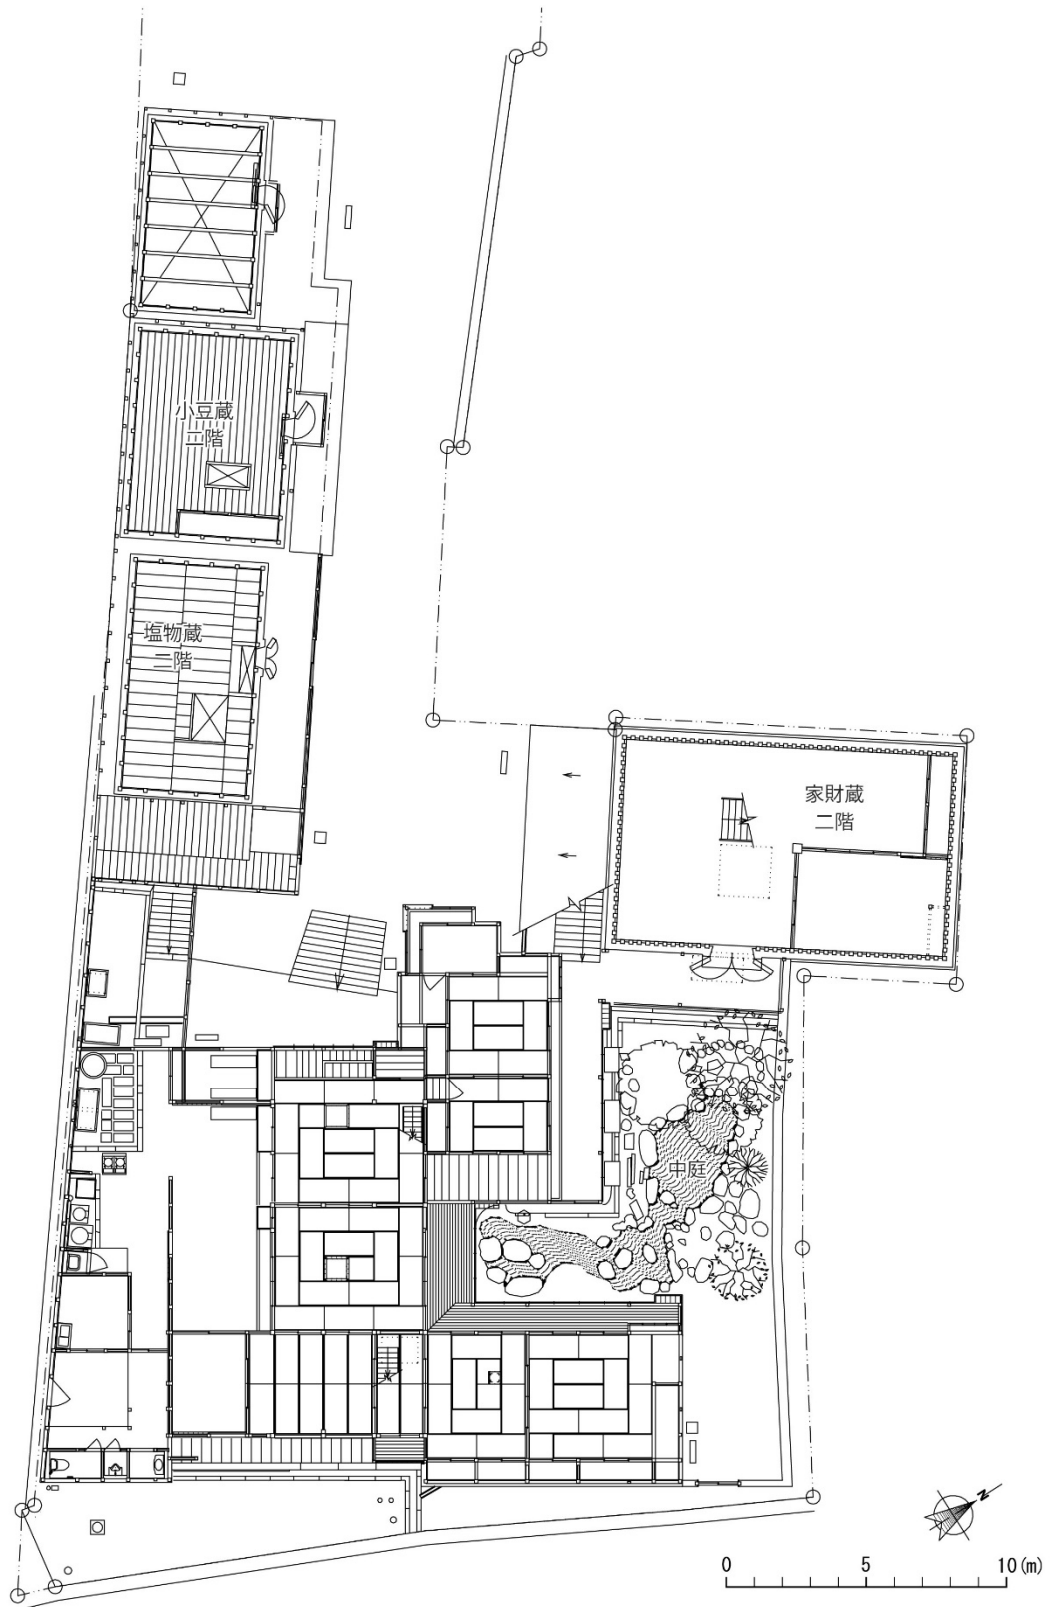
旧角海家住宅 平面図 (主屋一階、家財蔵二階、塩物蔵二階、小豆蔵二階)
